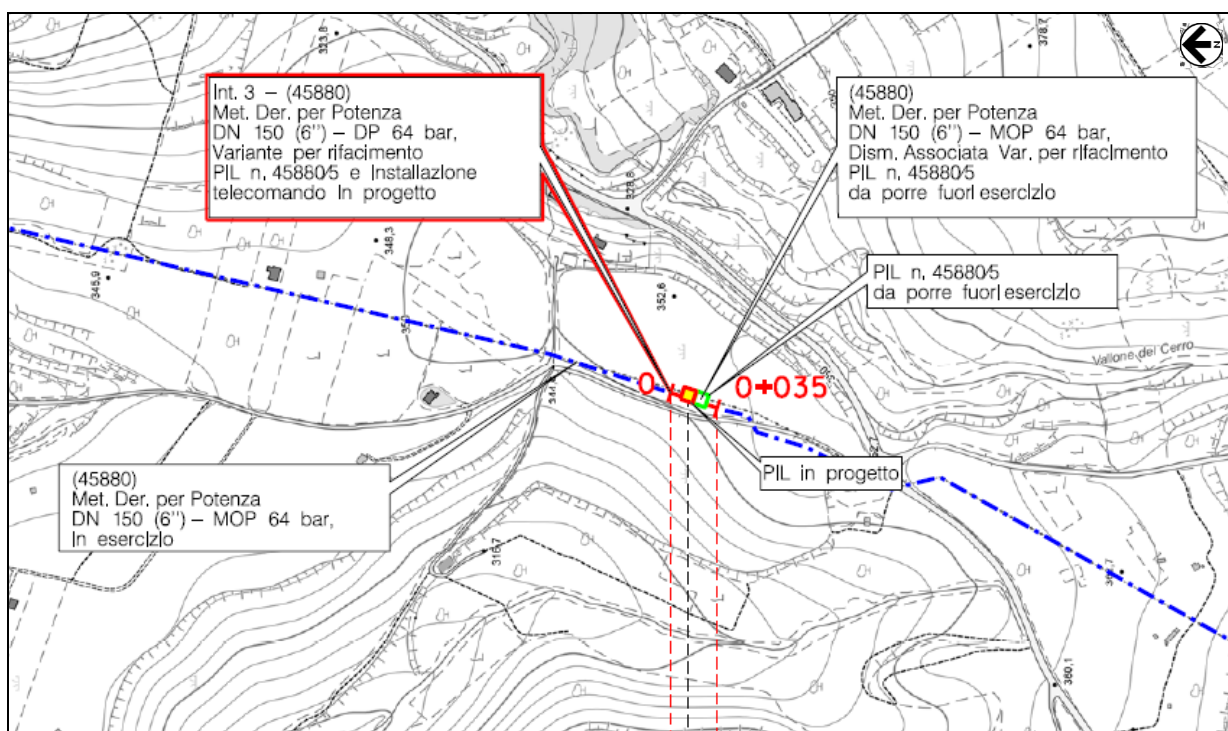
/C.b – Planimetria 1:5.000 con localizzazione dell'area dell'Intervento n.3 (progetto in rosso, dismissione in verde, esistente in blu)
